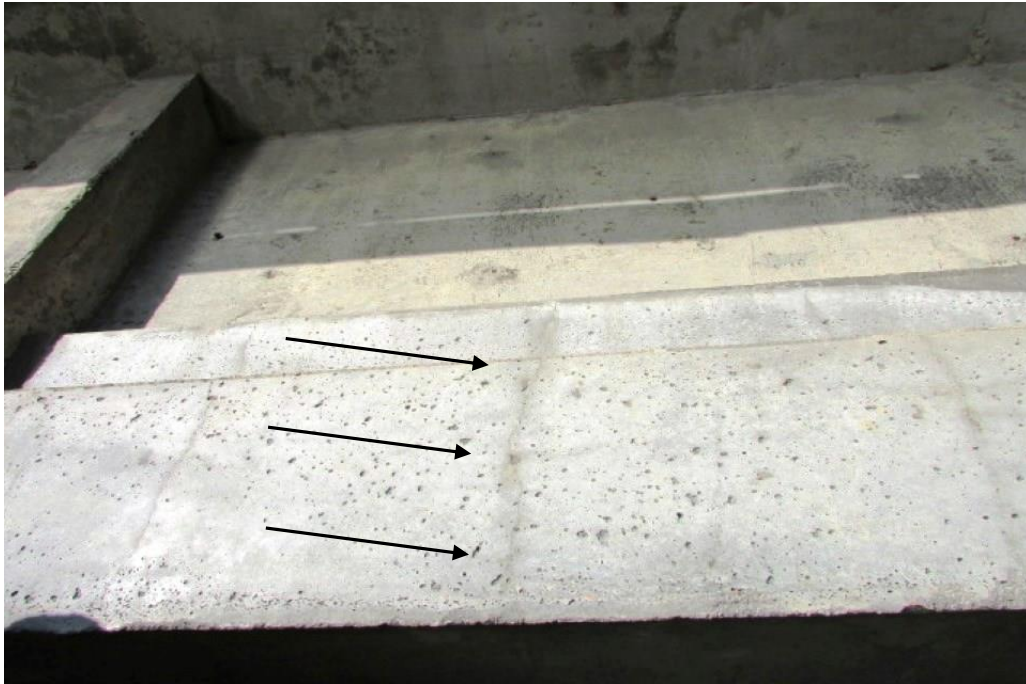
Face lateral longarina VL04 – fissura superficial com abertura máxima de 0,2 mm no trecho de reforço existente junto à mesa inferior da viga longarina
